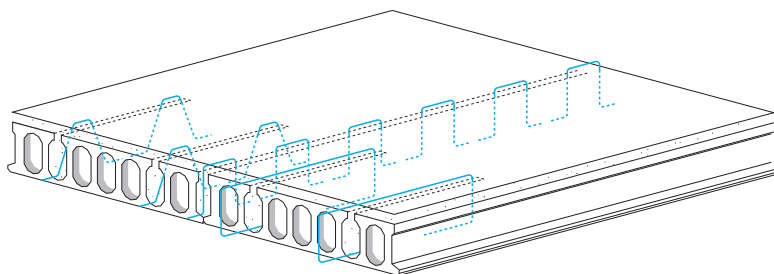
Eventuali armature di collegamento fra solaio alveolare e cappa collaborante gettata in opera.
